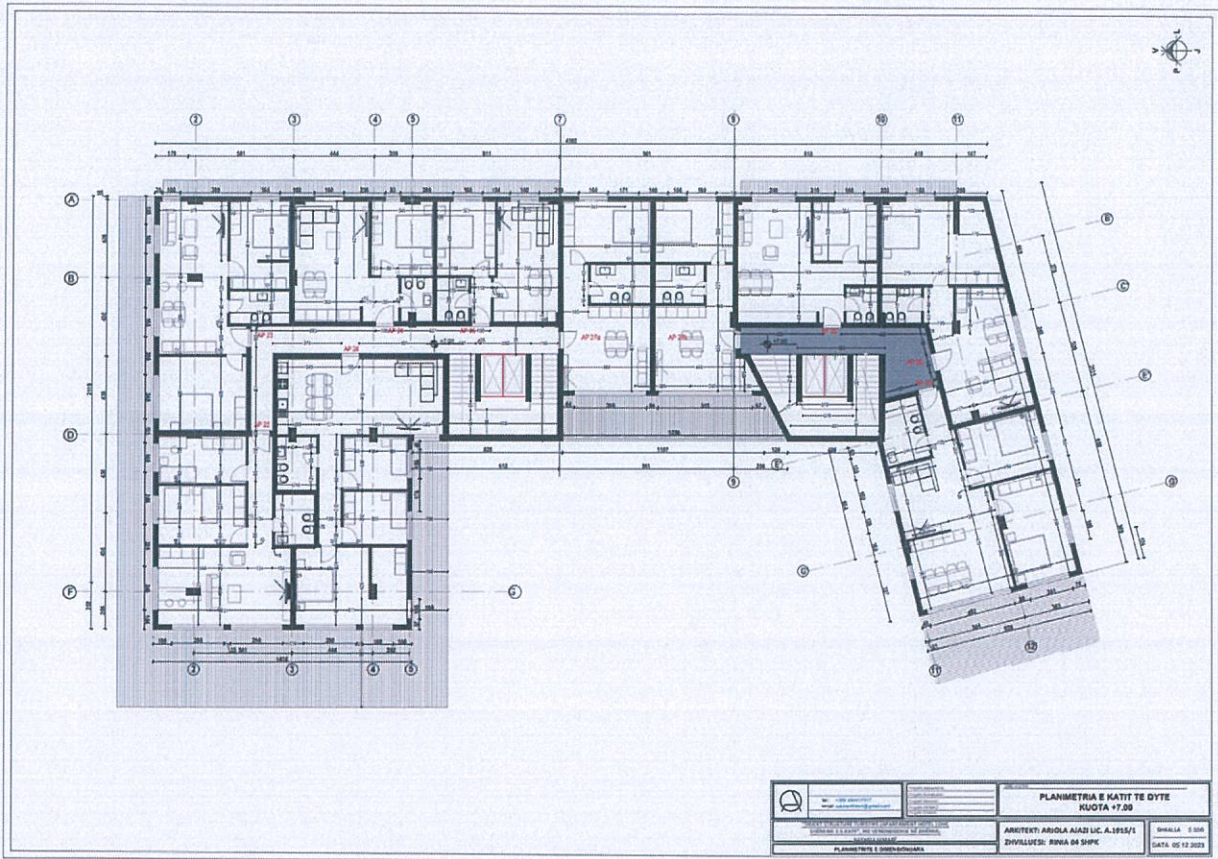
Planimetri e katit te dyte (kuota 7.00)
